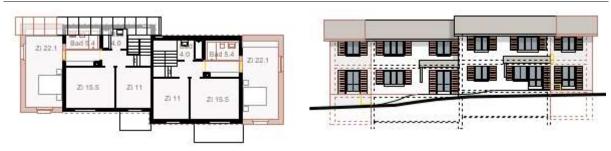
Grundriss mit seitlichem, zweigeschossigen Anbau eines Doppeleinfamilienhauses
